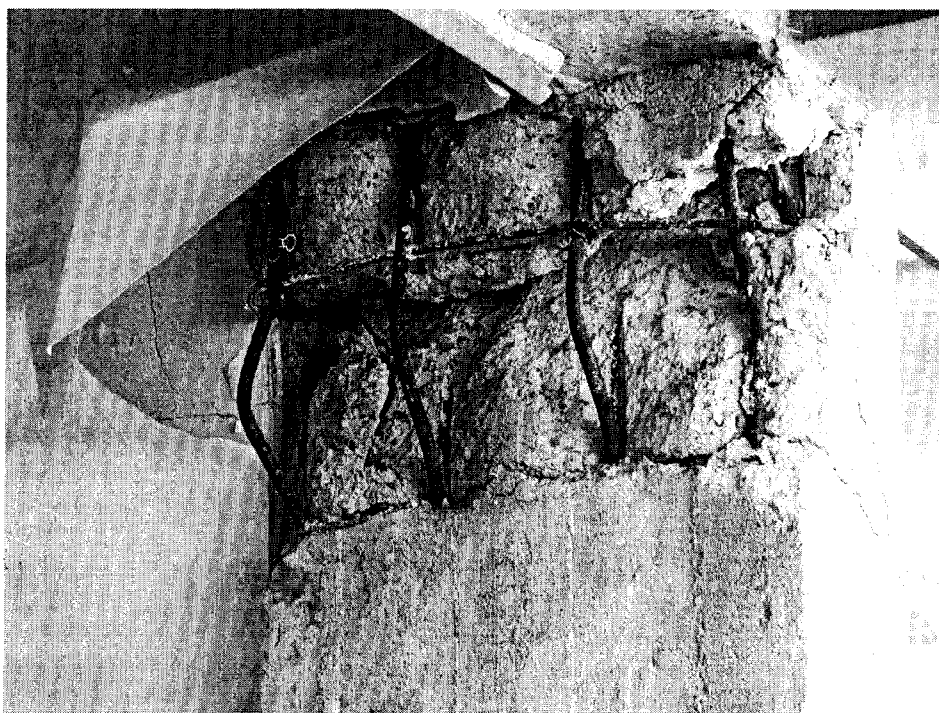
Columna fallada con poco acero trasversal y alta corrosión.
